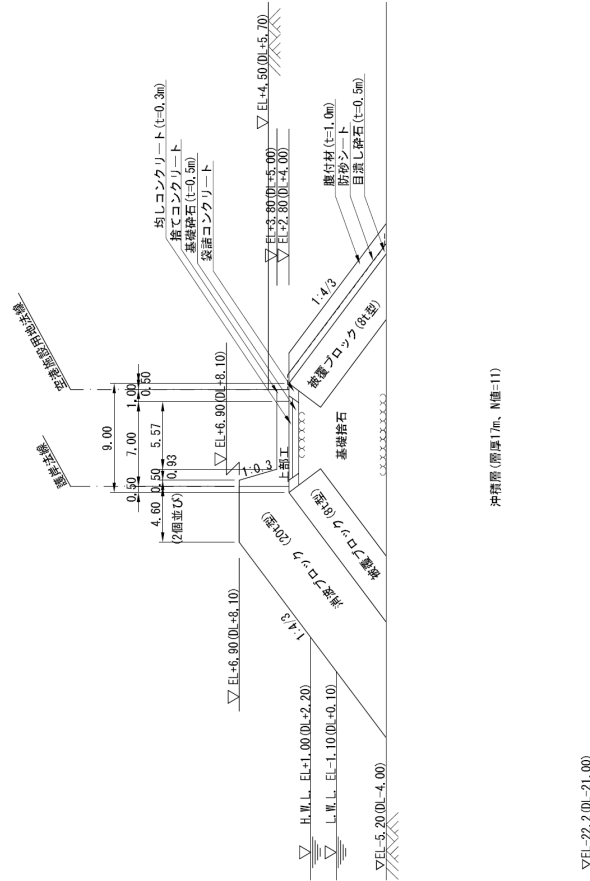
(7) 代替施設本体の傾斜堤護岸断面図
